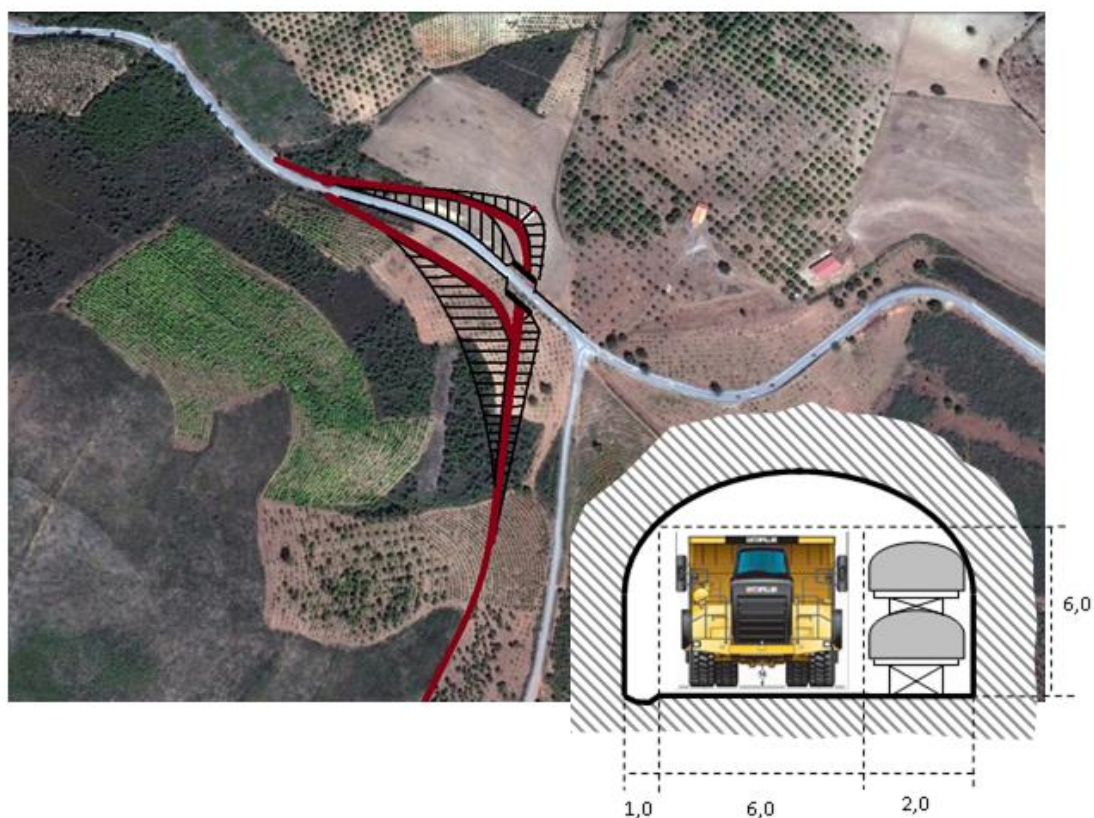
Túnel no Nó da estrada a construir de ligação da Lavaria à EN 220
